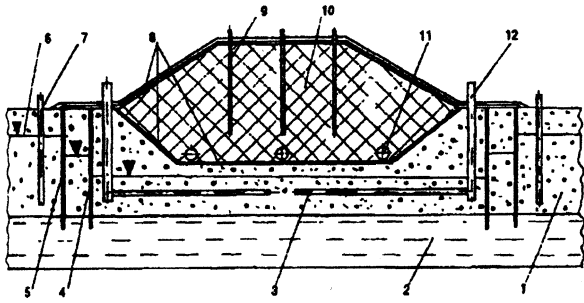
Схема комплекса защитных инженерных мероприятий, отраженных на стадии закрытия заполненной отходами карты полигона ТБО: 1 – верхняя толща водонасыщенного грунта; 2 – подстилающий водонепроницаемый грунт; 3 – горизонтальные трубопроводы водопонижительной системы; 4 – противofильтрационная завеса первого контура; 5 – то же второго контура; 6 – уровень грунтовых вод; 7 – скважина для наблюдения за состоянием воды за пределами защищенного контура; 8 – гидроизоляционные слои днища и откосов котлована, а также кровли отходов; 9 – газосборные скважины; 10 – толща отходов; 11 – трубопроводы системы сбора и удаления фильтрата; 12 – водозаборная скважина водопонижительной системы
